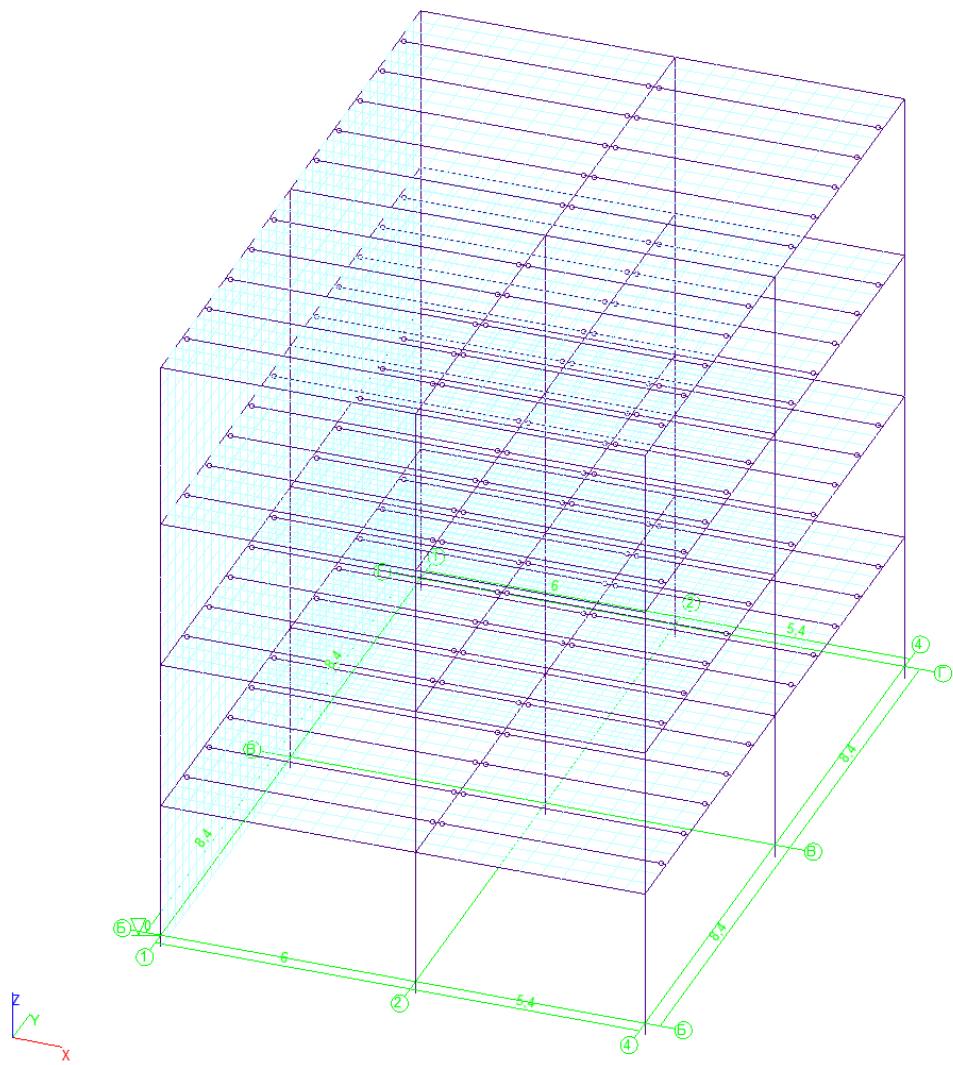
Расчетная схема поперечника (каркас с пластинами)
